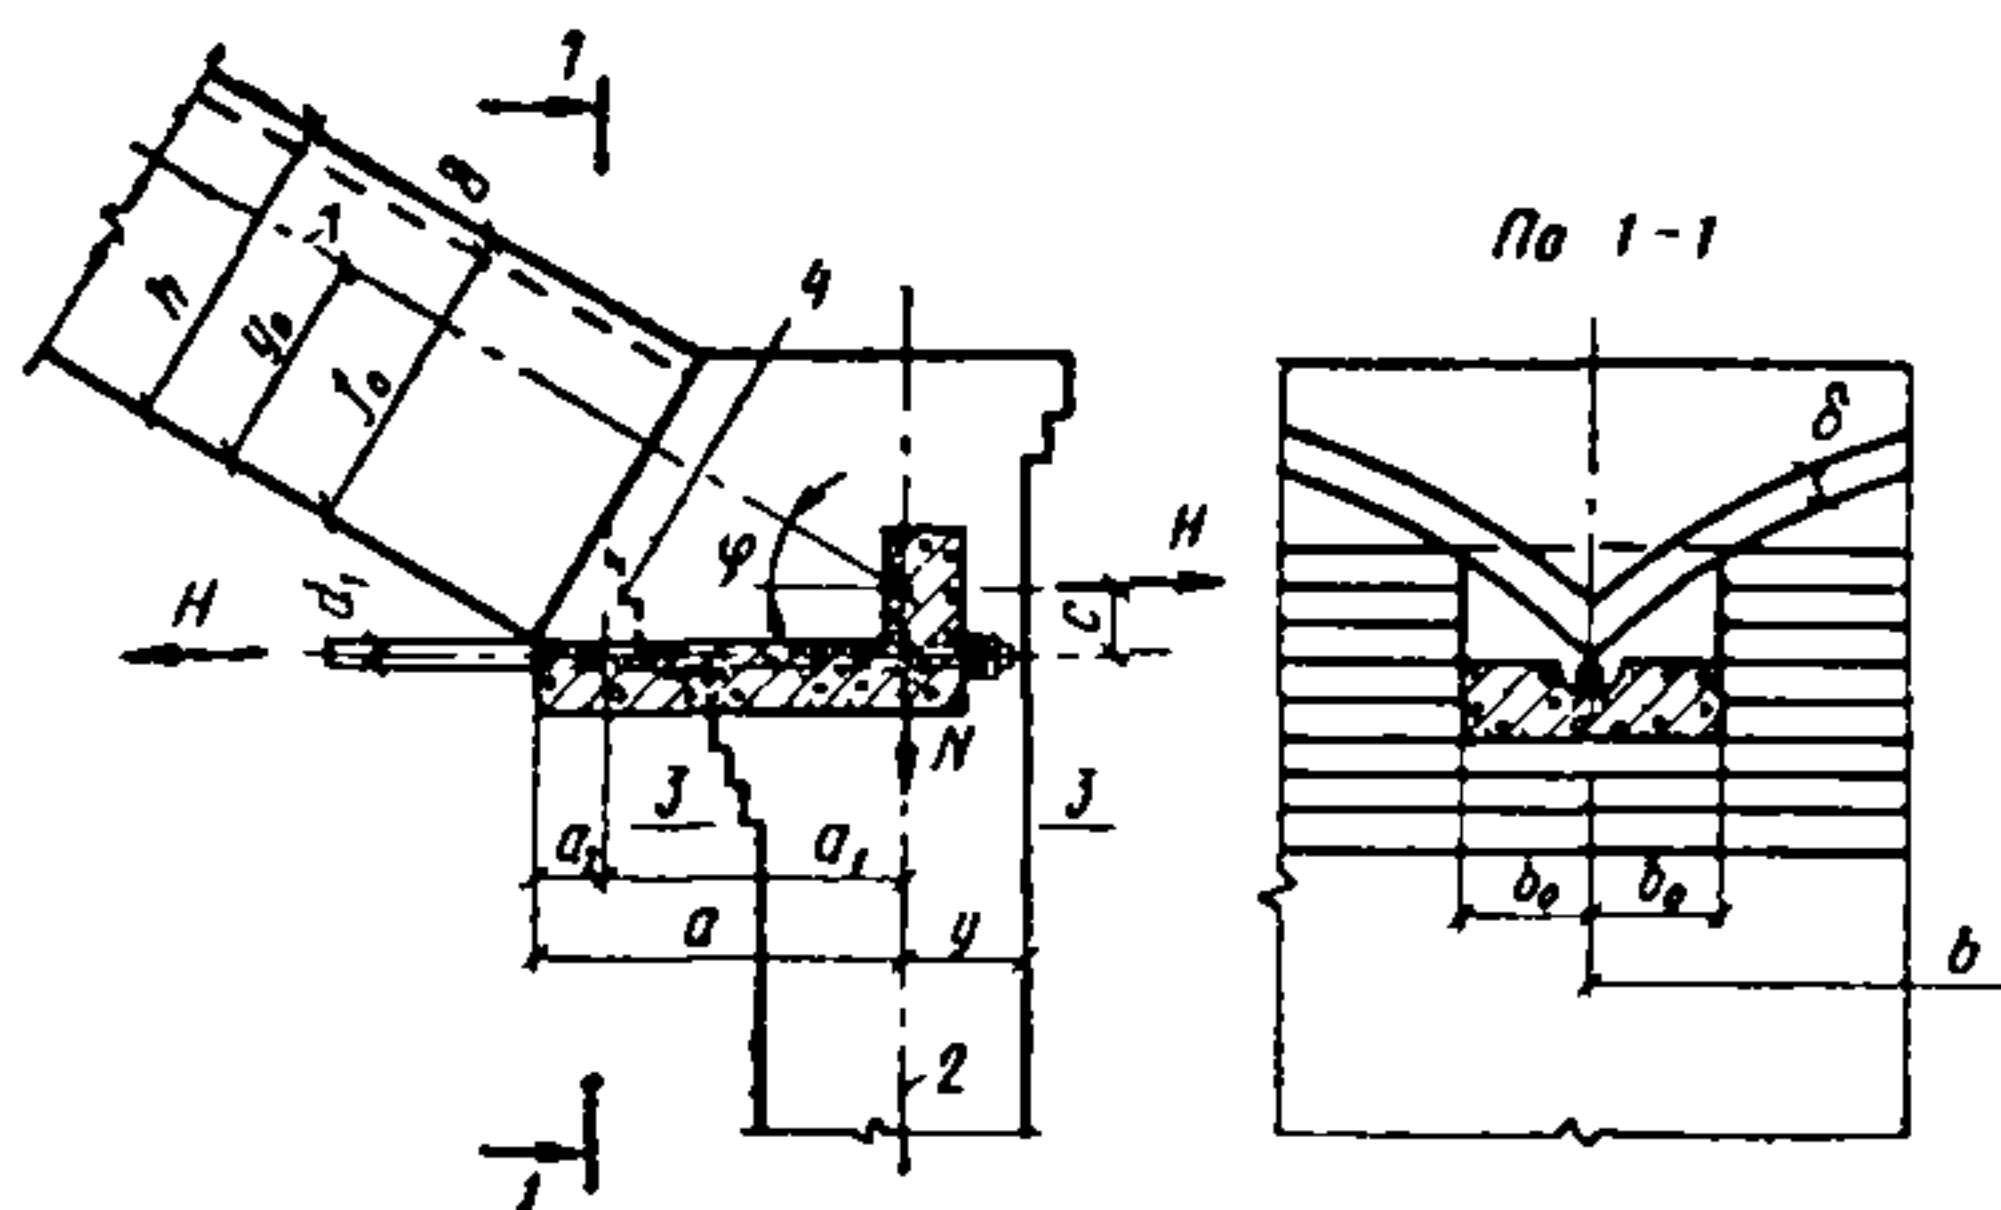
Расчетная схема опорного узла свода двойной кривизны
